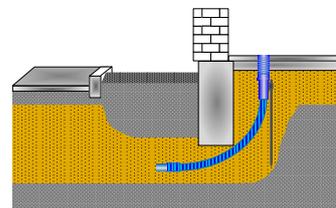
Gebäudeeinführungen Beispiele für Hauseinführungsvarianten
